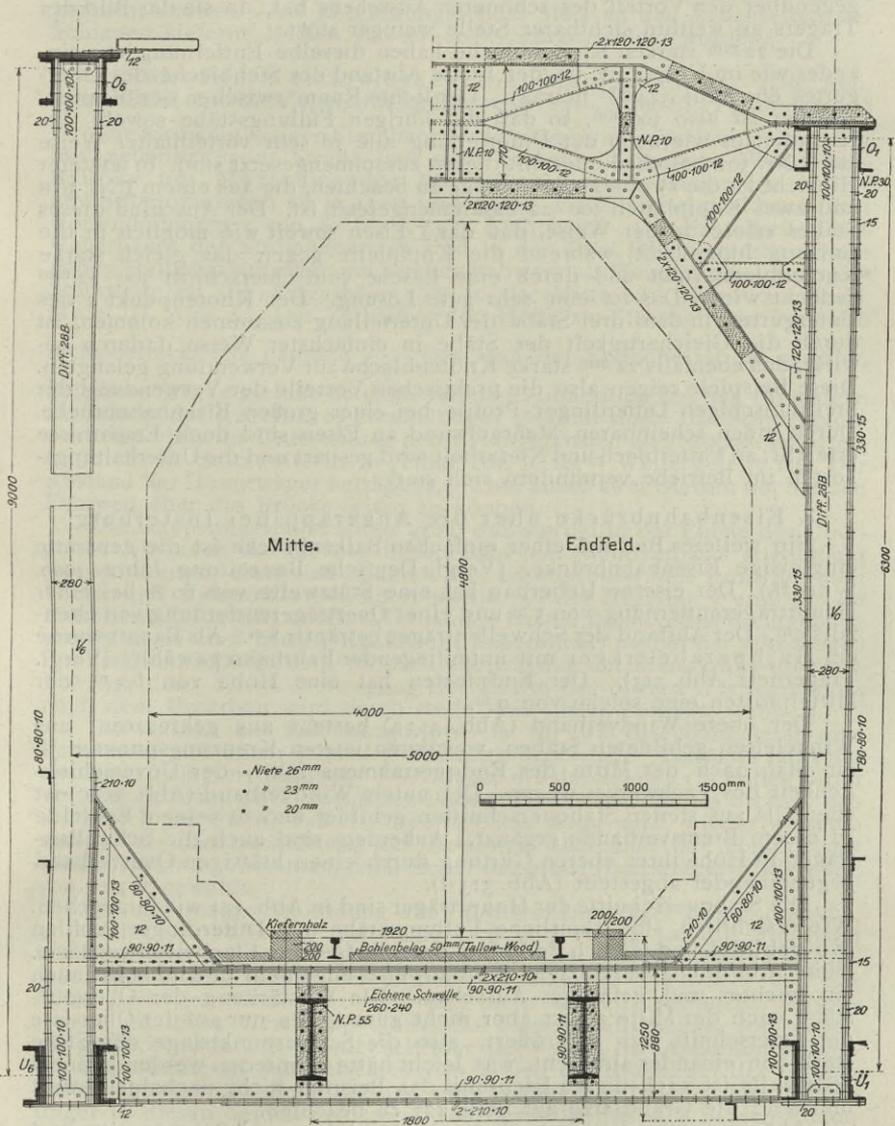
Querschnitt der Angerapp-Brücke bei Insterburg. (Aus D. B. Z. 1909, S. 510).
